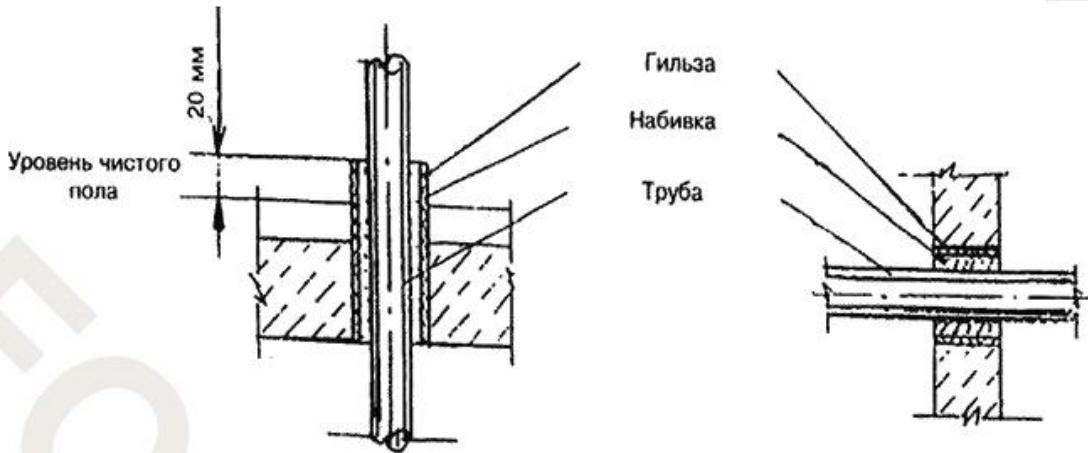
Установка гильзы для прокладки труб в стенах и перекрытиях
